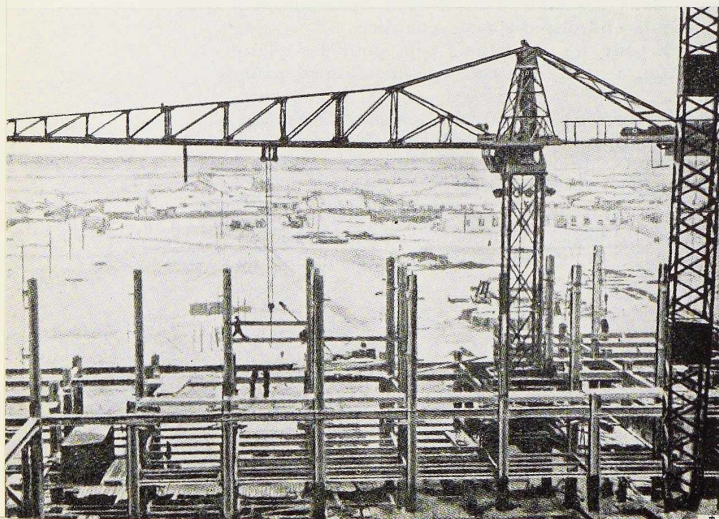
Détail de l'assemblage des poutres et des colonnes.
